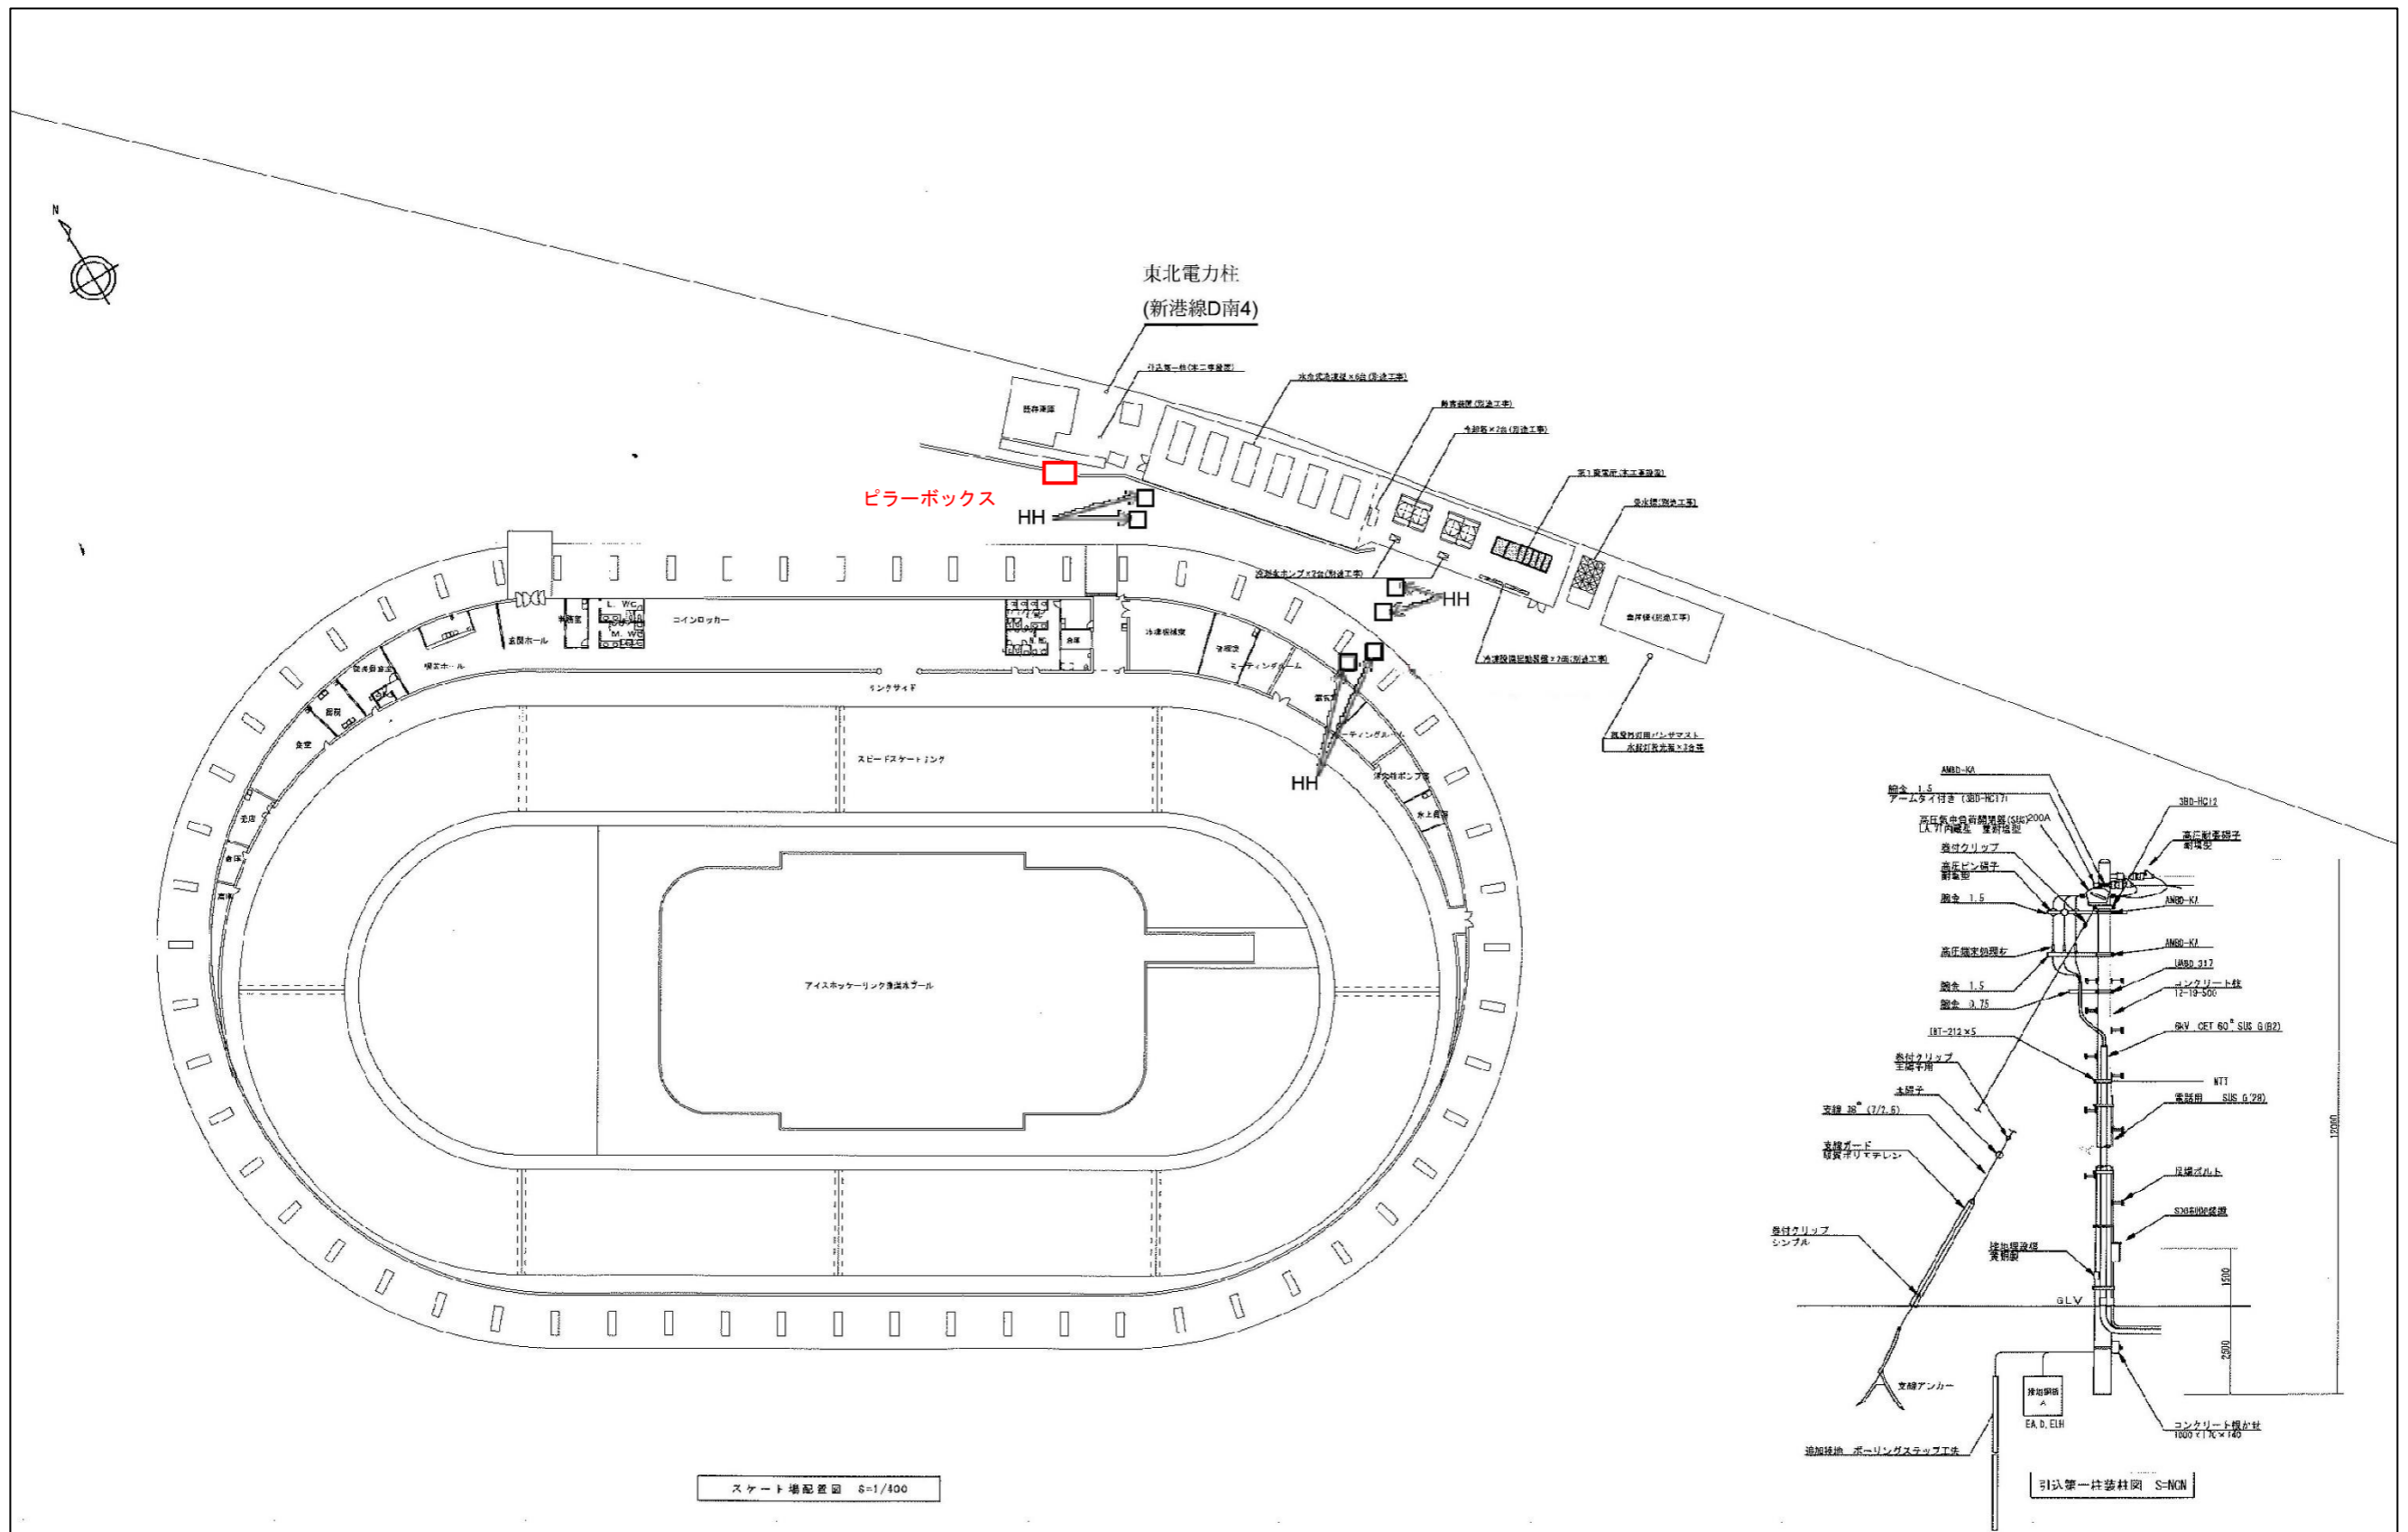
県立スケート場平面図 (ピラーボックス設置位置案)
